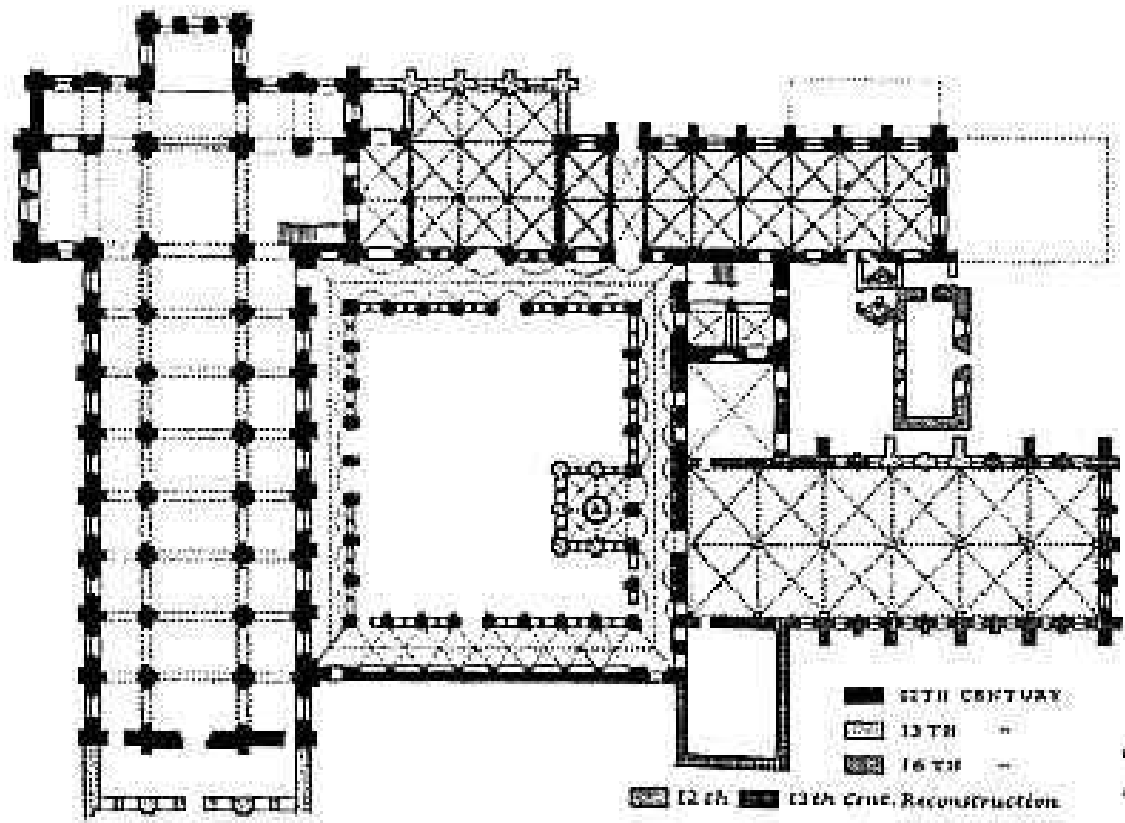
Zisterzienserabtei Fontenay, Grundriss
